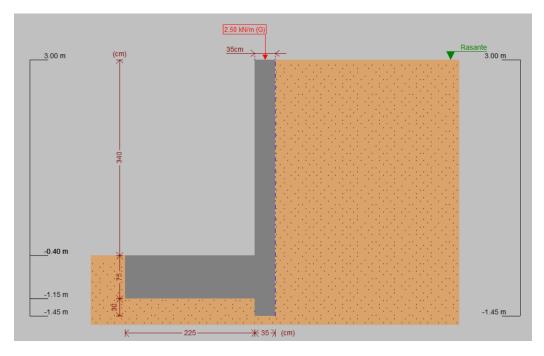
Geometría muro de ménsula. Fuente: CYPE 2019
